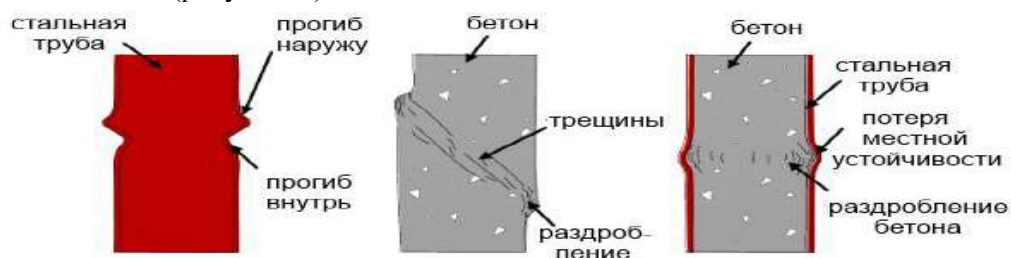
Модель разрушения металлической трубы, бетонной и сталетрубобетонной колонны в схемах
